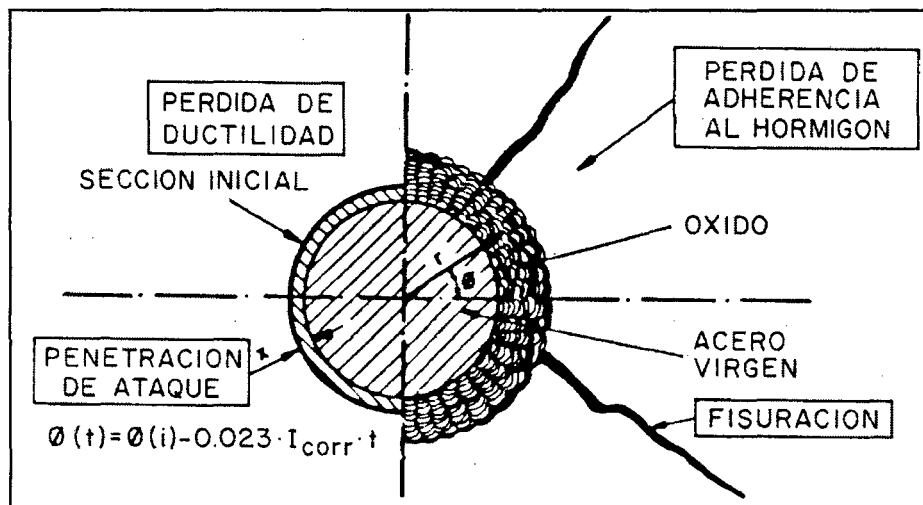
Consecuencias de la corrosión de las armaduras en el comportamiento estructural.
